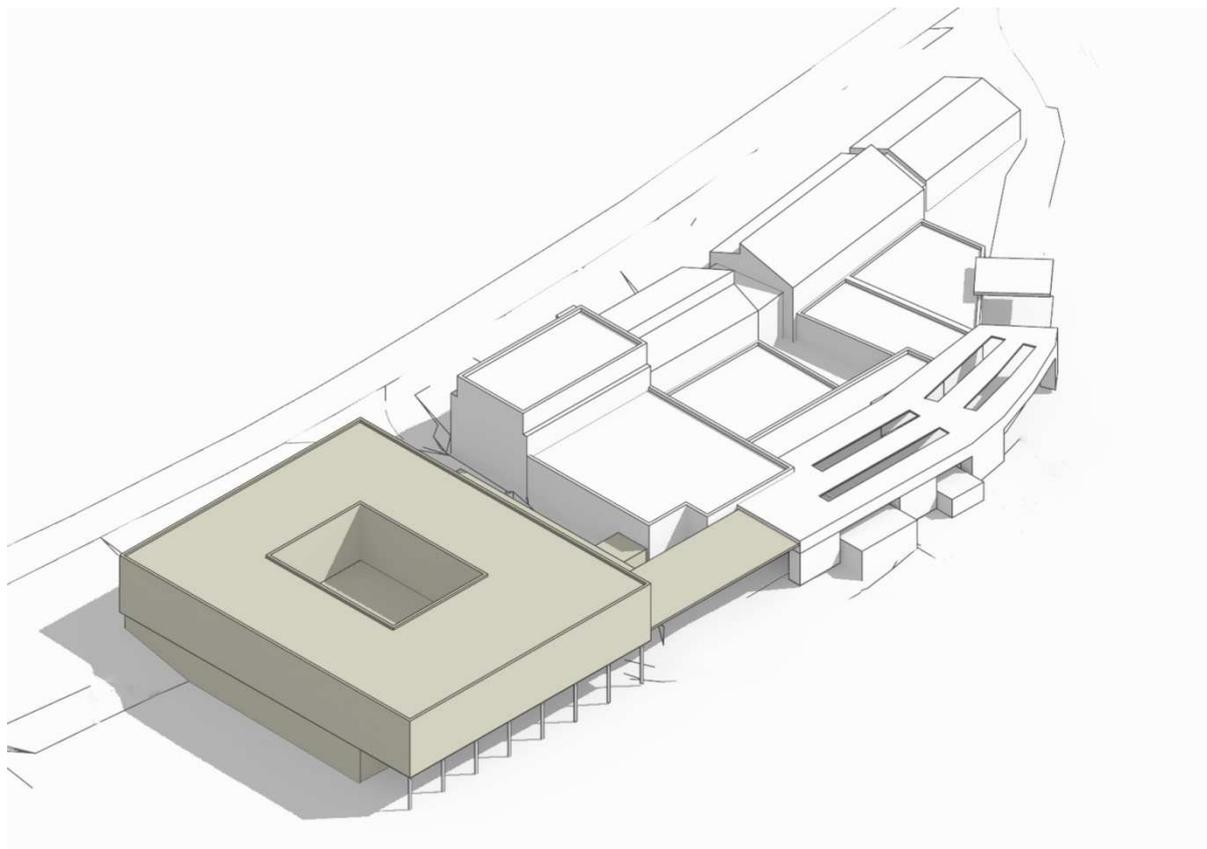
Variante 2.3 [finaler Stand, 27.02.2017] 3D-Massenmodell, Ansicht SW
